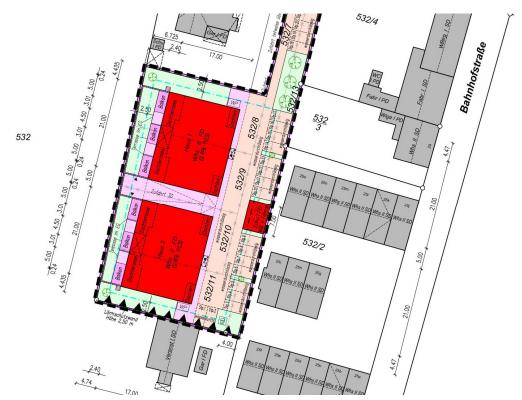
Lageplan Bauvorhaben Westliche Brühlstraße 3a
